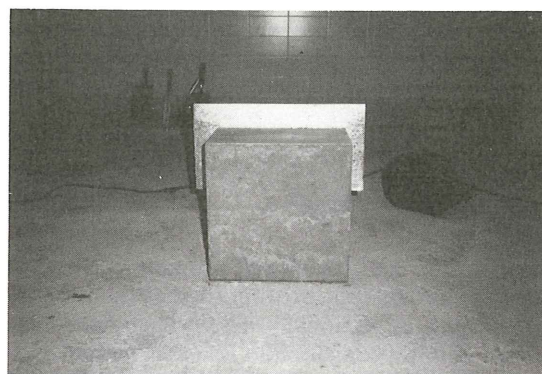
Vista general de una probeta desmoldeada y girada, previa a la extracción de la lámina de la fisura.
